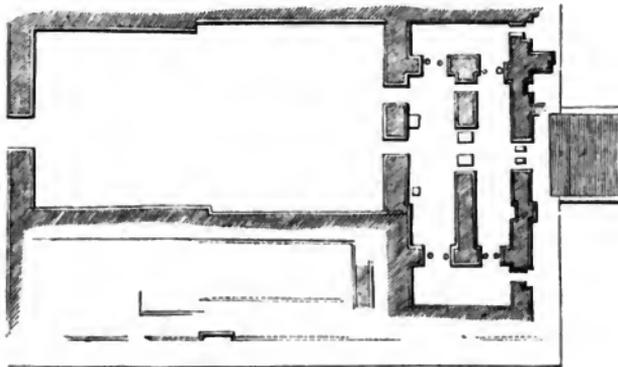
Grundriss des Palastes des Essarhaddon zu Nimrud.
